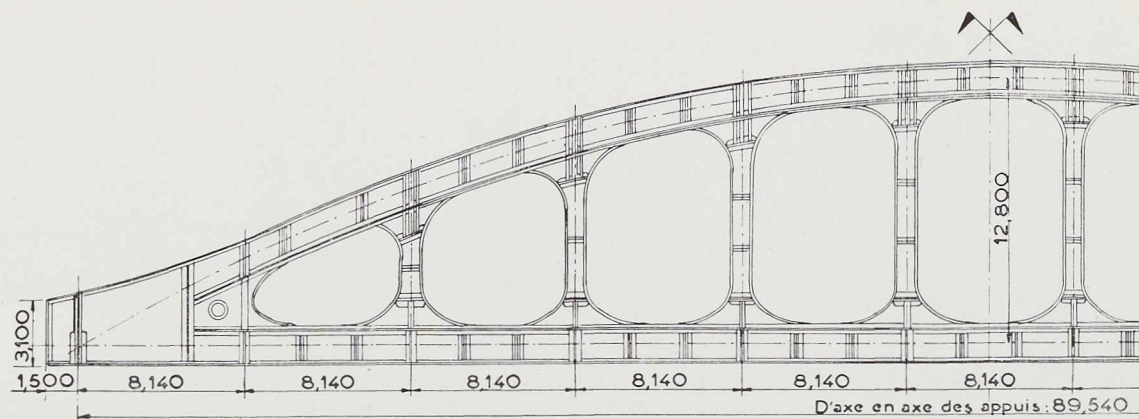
Demi-élévation d'une poutre principale, constituée par un arc parabolique surbaissé au 1/7, avec onze panneaux.
